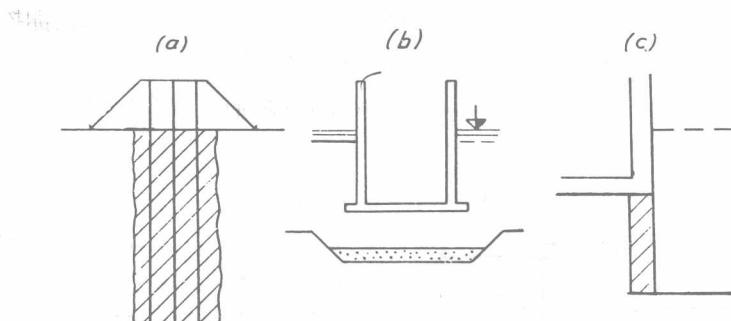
特殊基礎施工：(a)土壤改良施工；(b)水中基礎施工；(c)原基礎加固施工
